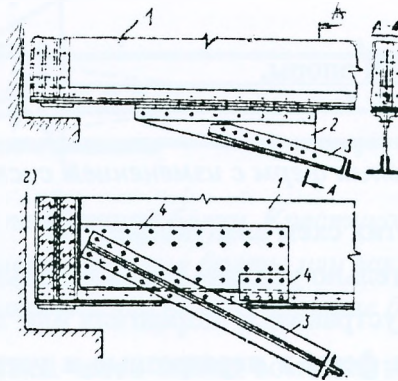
Шпренгели для усиления сплошных ферм: 1 – вертикальный лист фермы; 2 – фасонка; 3 – шпренгель; 4 – накладка.
